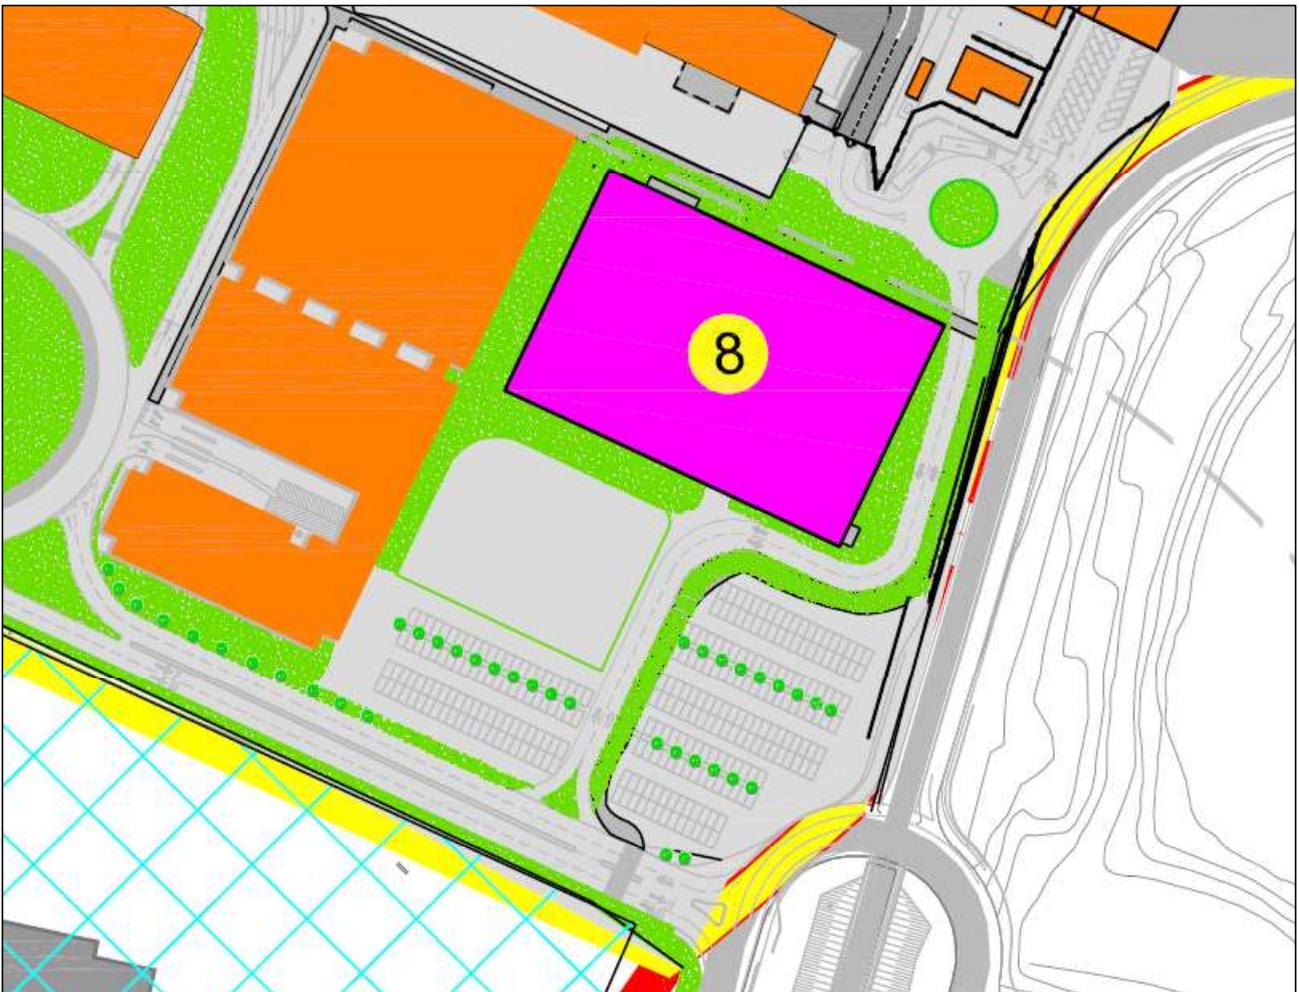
Estratto Master Plan – Nuovo Parcheggio Multipiano Est
